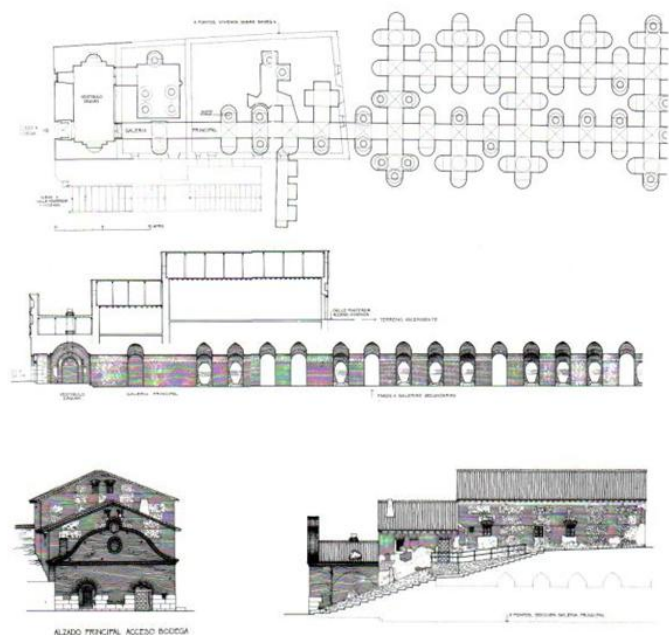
Levantamiento realizado por J. Sandoval en 1991. Planta, alzado y perfiles.
